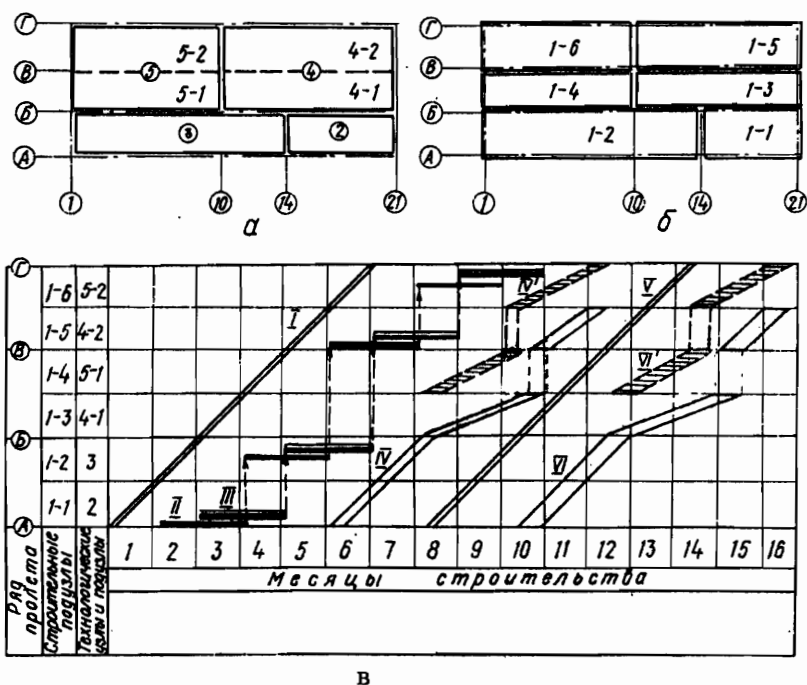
Увязка основных строительно-монтажных работ с конвейерно-блочным монтажом покрытия: а - технологические узлы и подузлы; б - строительные подузлы; в - схема увязки основных СМР; I - земляные работы; II - устройство фундаментов под каркас здания; III - монтаж колонн и подкрановых балок; IV - возведение фундаментов под оборудование; V - конвейерно-блочный монтаж покрытия; VI - монтаж технологического оборудования
